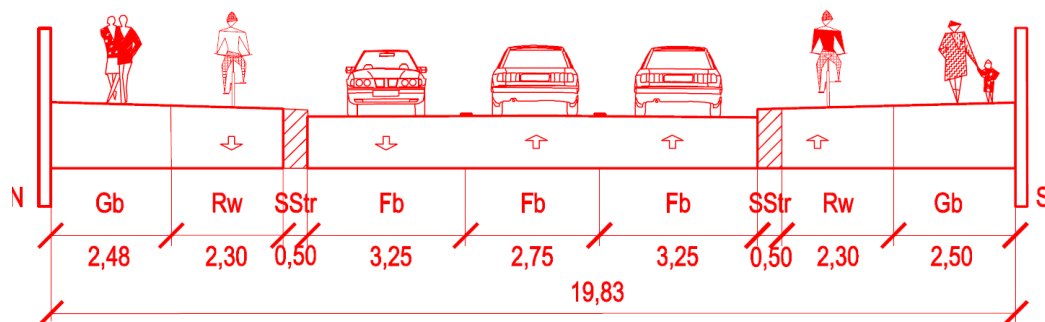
Schematische Darstellung Querschnitt westlich Knotenpunkt Leopoldstraße / Rheinstraße - Planung Variante 2 (Quelle: Ing.-Büro Zimmermann)
